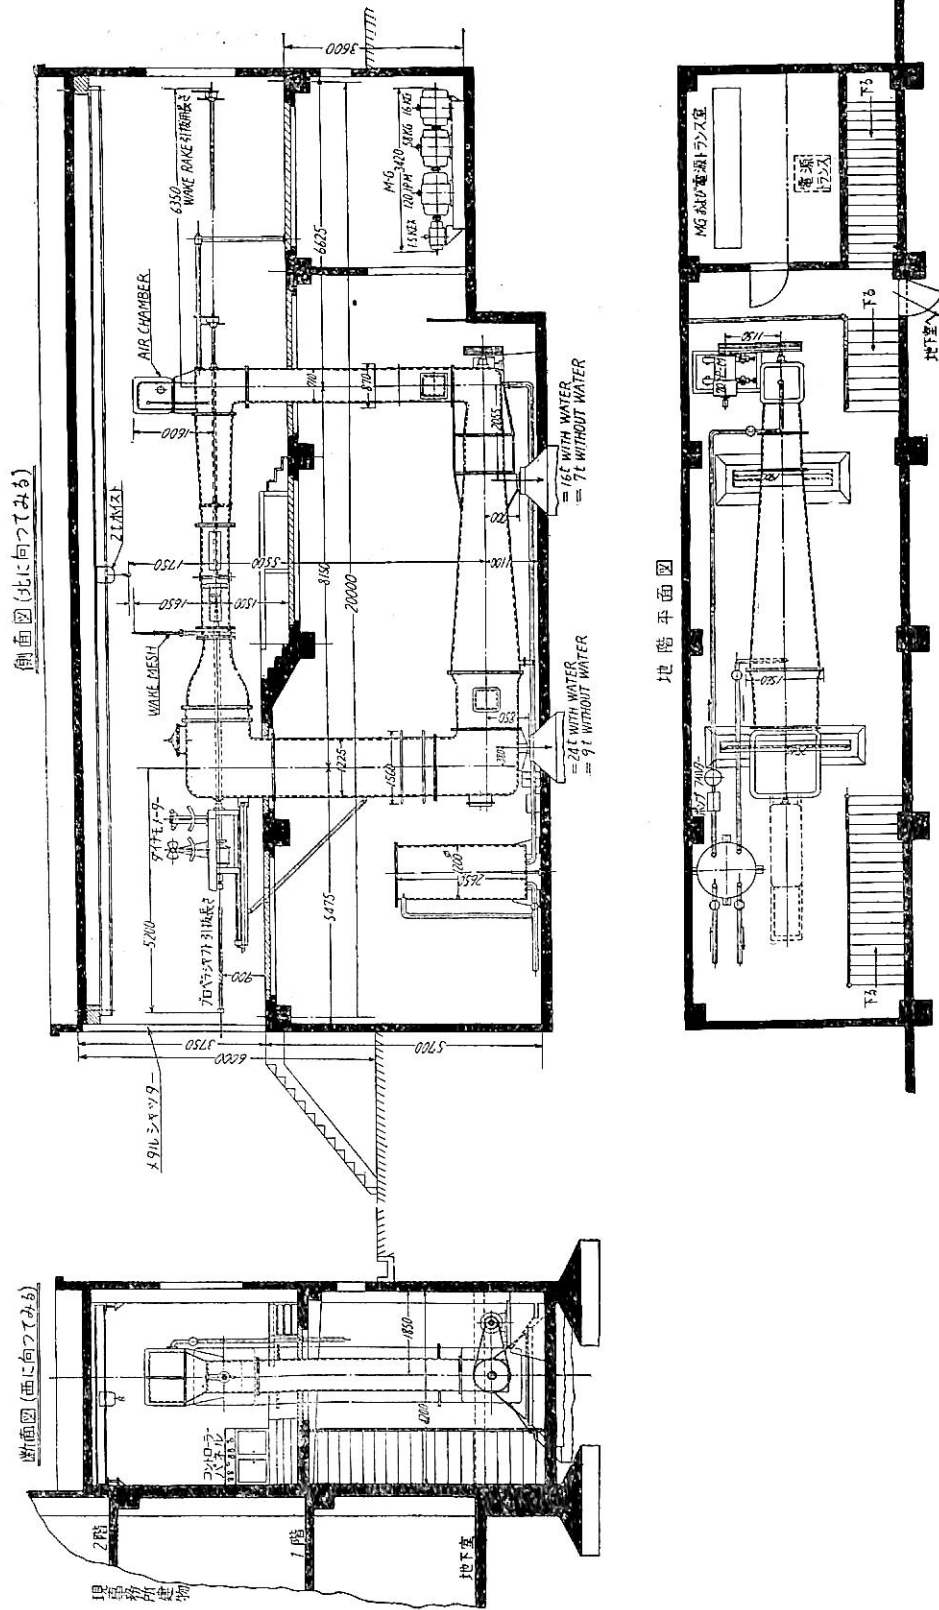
空洞水槽室 (側面図, 平面図および断面図)
